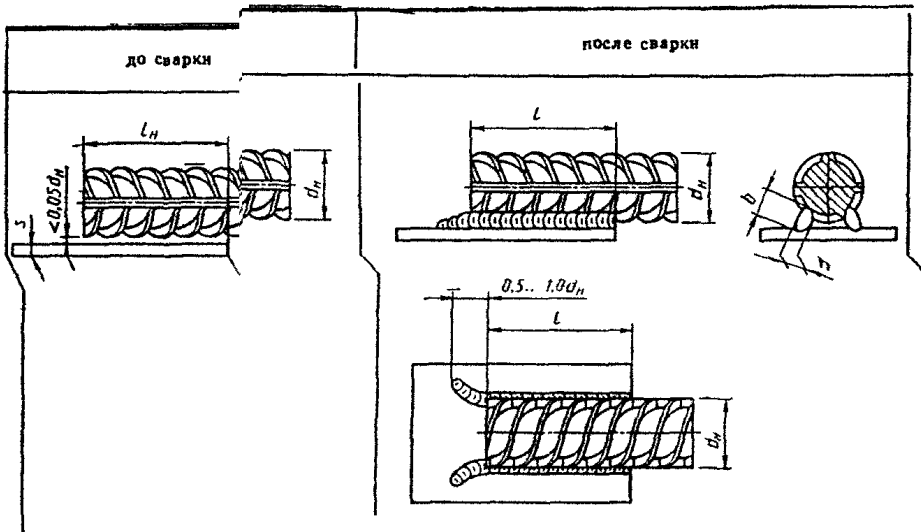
Конструкция нахлестного соединения, выполняемая ручной дуговой сваркой протяженными швами (тип НI-Рш)
